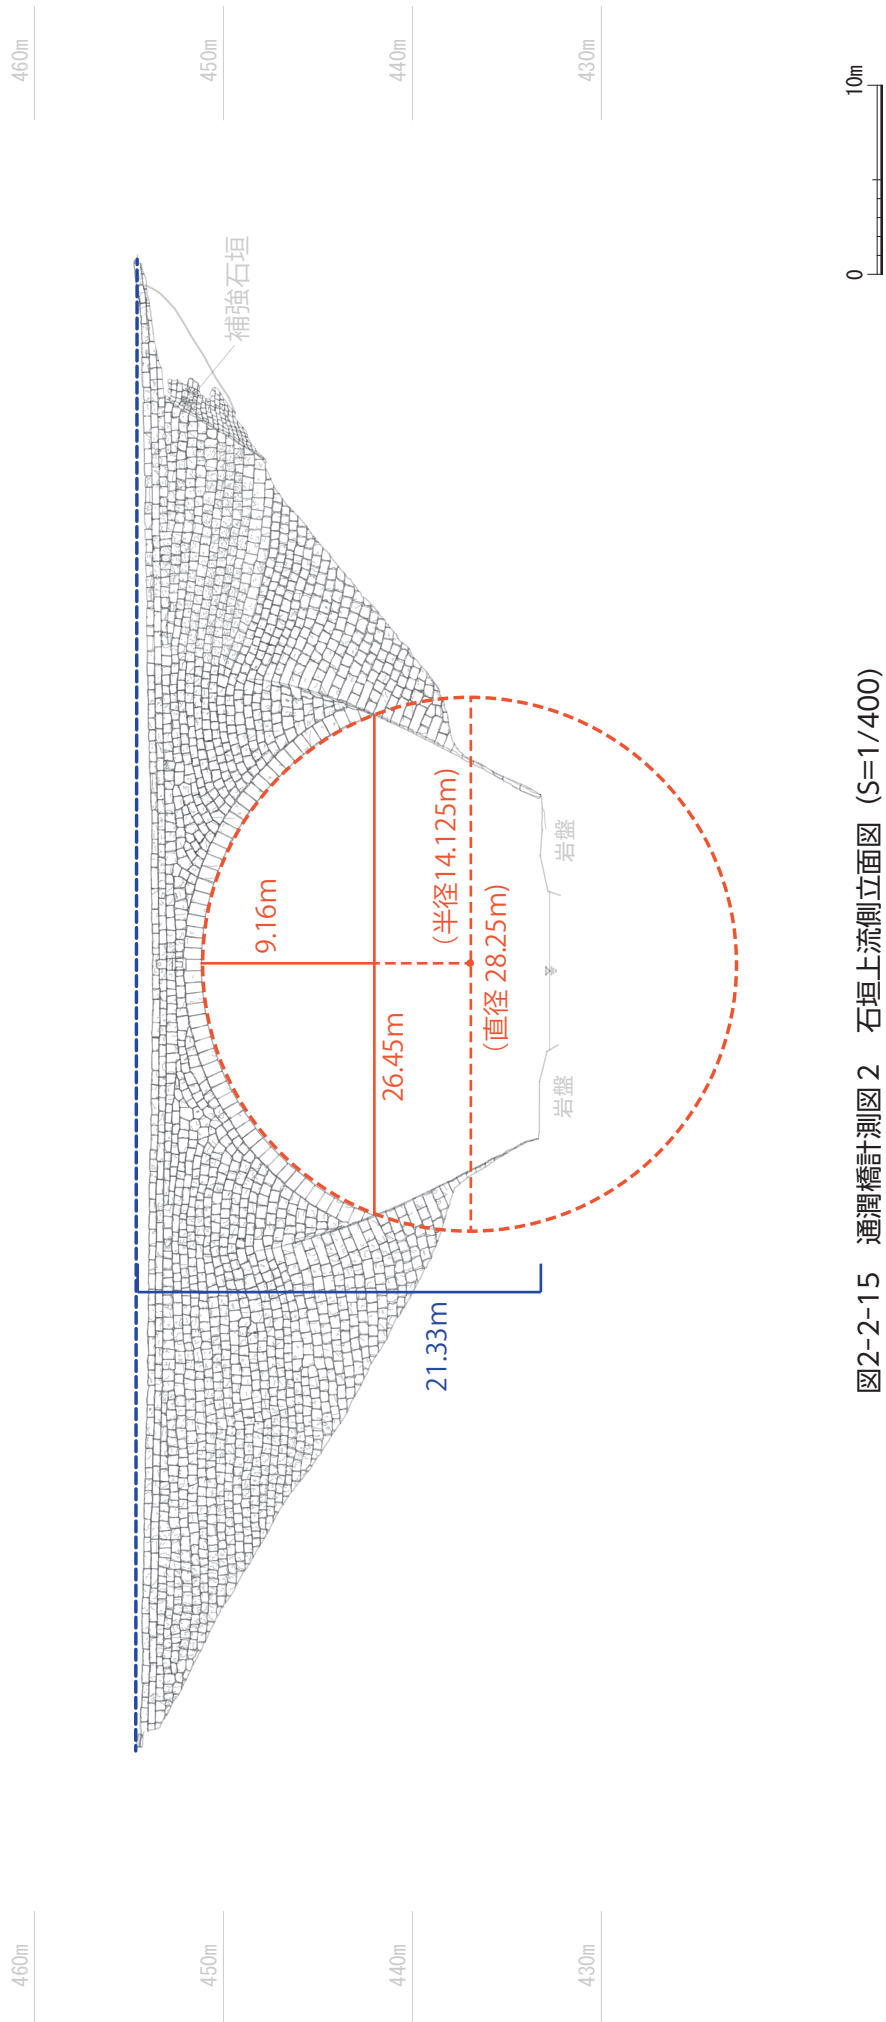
通潤橋計測图2 石垣上流側立面图 (S=1/400)
